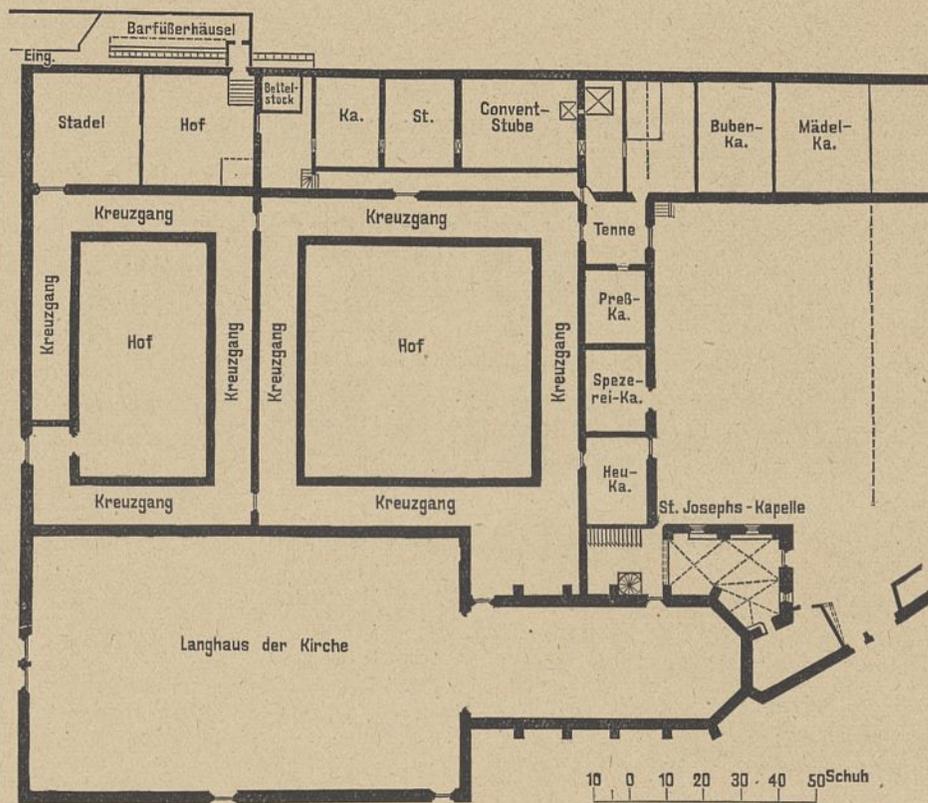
Ehemalige Barfüßerkirche, Grundriß mit Kloster.
